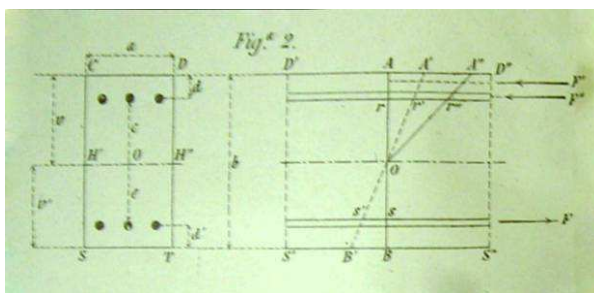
Diagrama de tensiones del hormigón armado propuesto por Considre. (Marv, 1902)
